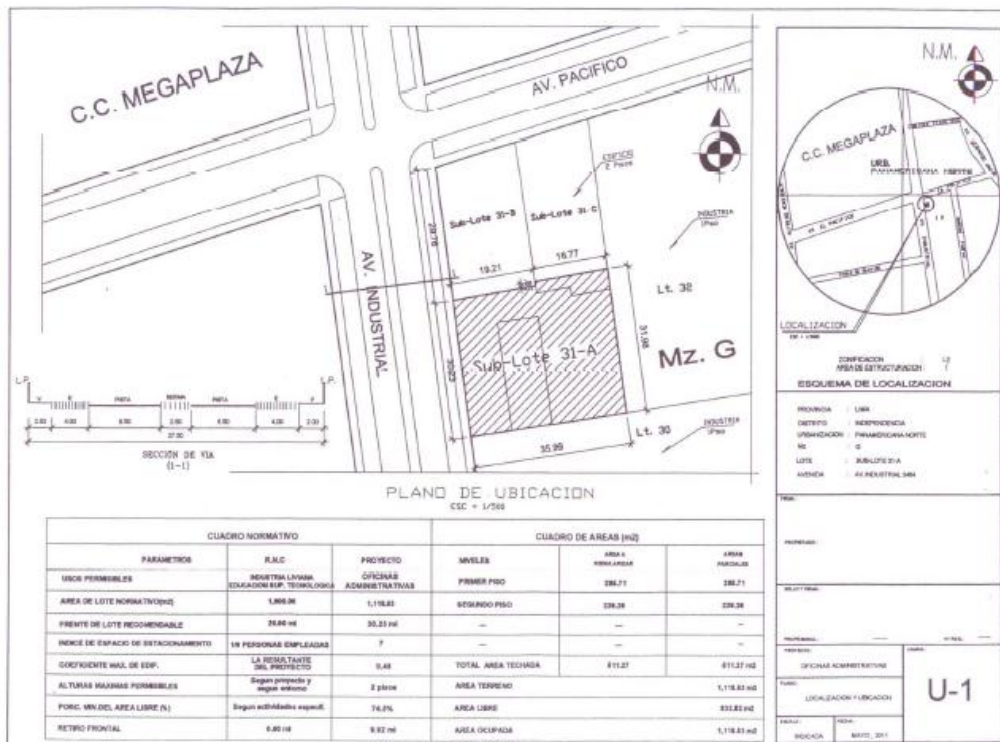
Certificado de parámetros del Subproyecto Lima Norte (Estacionamientos)
